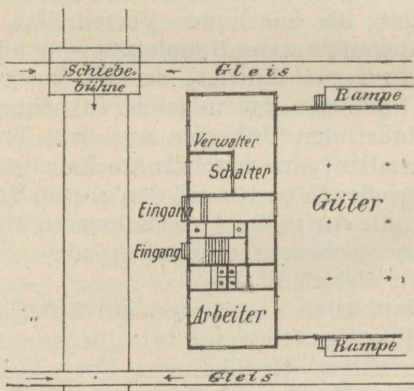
Mehrgeschossiger Bauteil einer großen Güterhalle.
